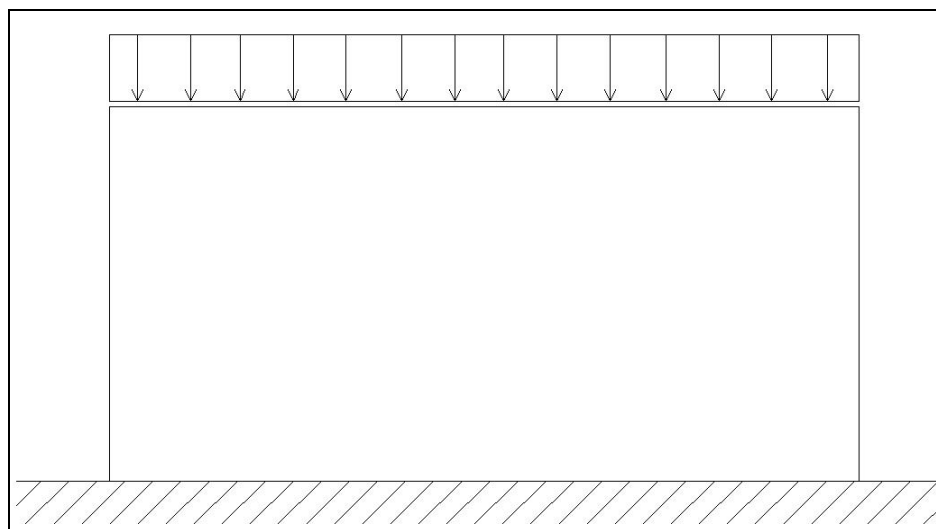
Carico distribuito dovuto al pacchetto stradale
